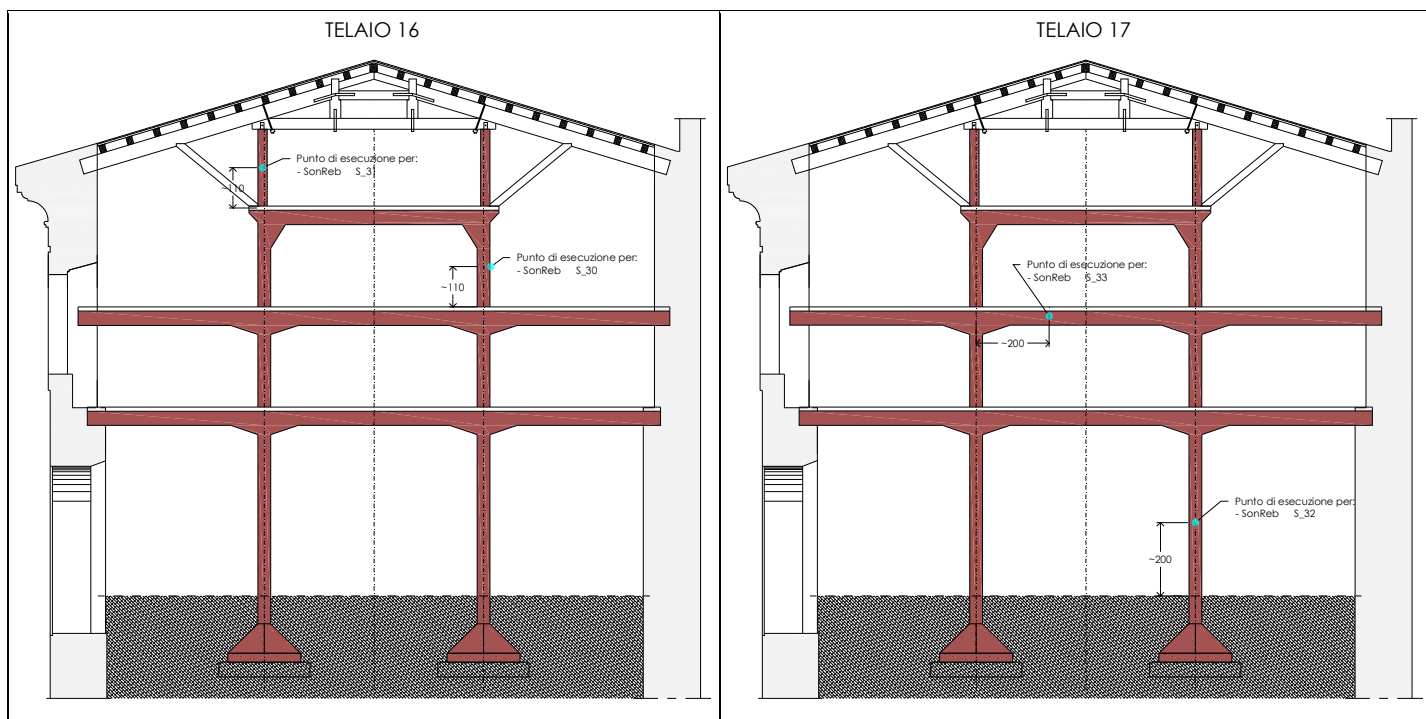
Posizione delle prove SonReb sui telai 16 e 17
